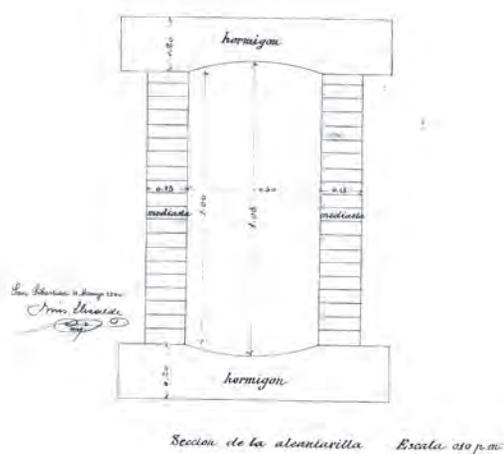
SECCIÓN DE LA ALCANTARILLA SEGÚN PROYECTO DE 1904
